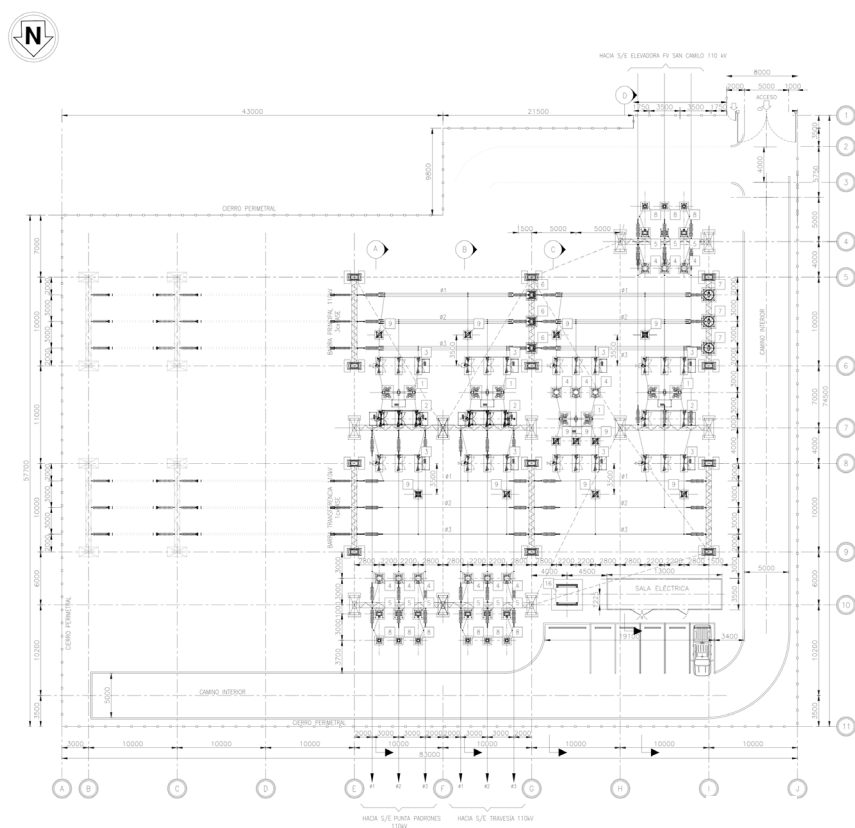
Plano de Planta de Subestación Seccionadora San Camilo 110kV.
